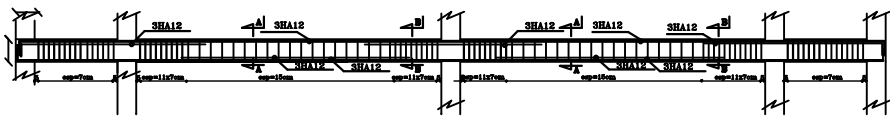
schéma de ferrailage de semelle aux appuis.
